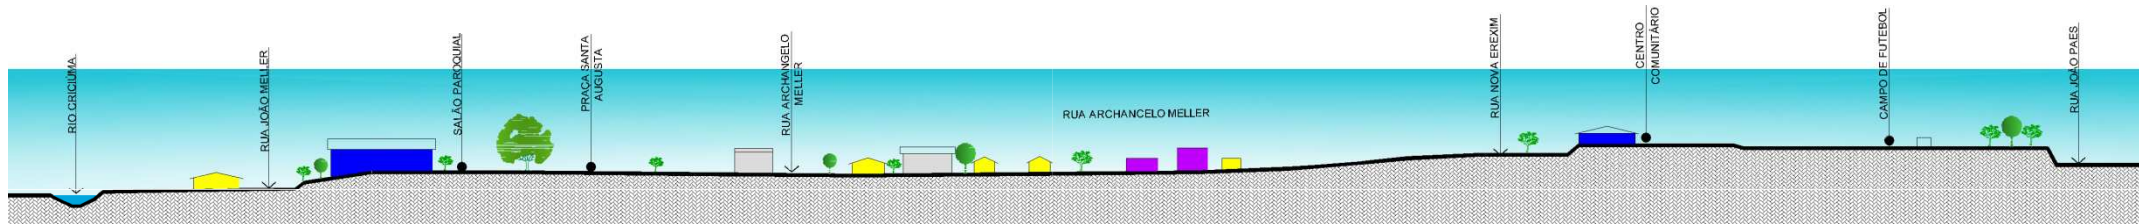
Corte Esquemático 02 – Rua Archangelo Meller
